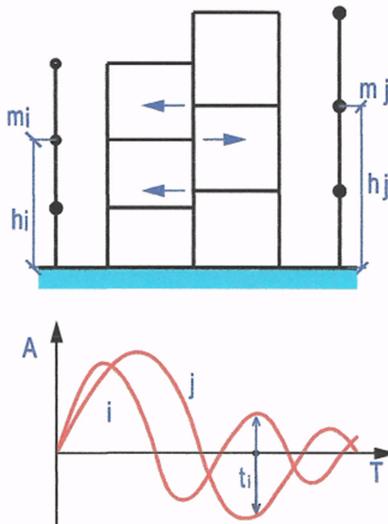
Влияние уровня размещения перекрытий на период собственных колебаний
